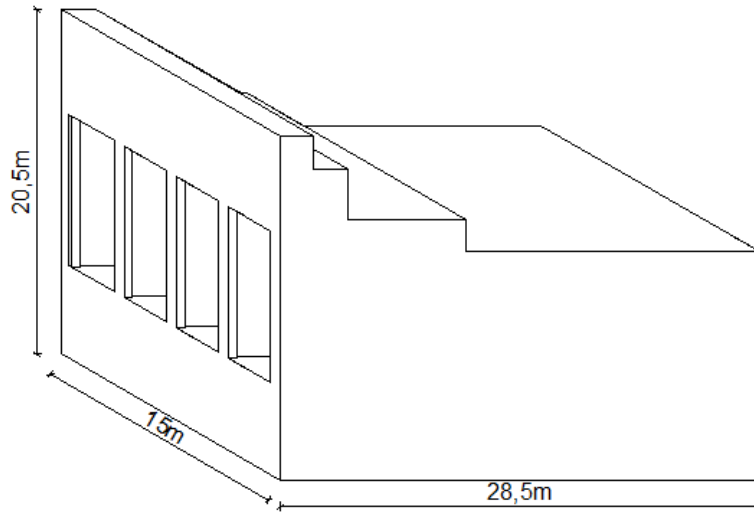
Dimensões gerais do caixotão do perfil corrente.
